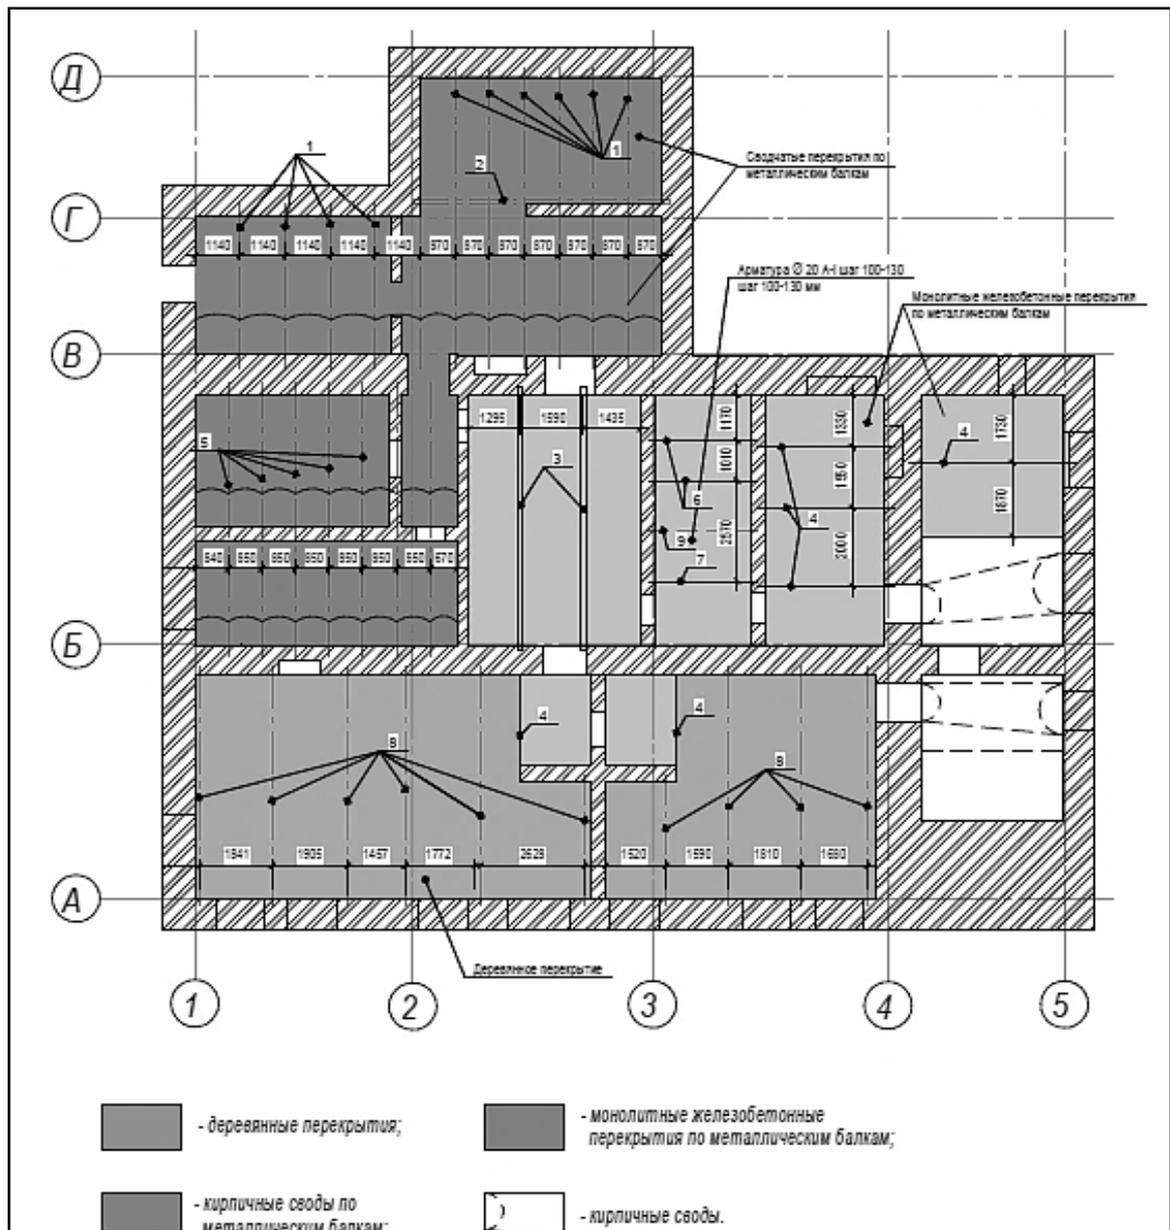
Схема расположения перекрытий: деревянных, монолитных железобетонных, сводчатых по металлическим балкам; кирпичных сводов
